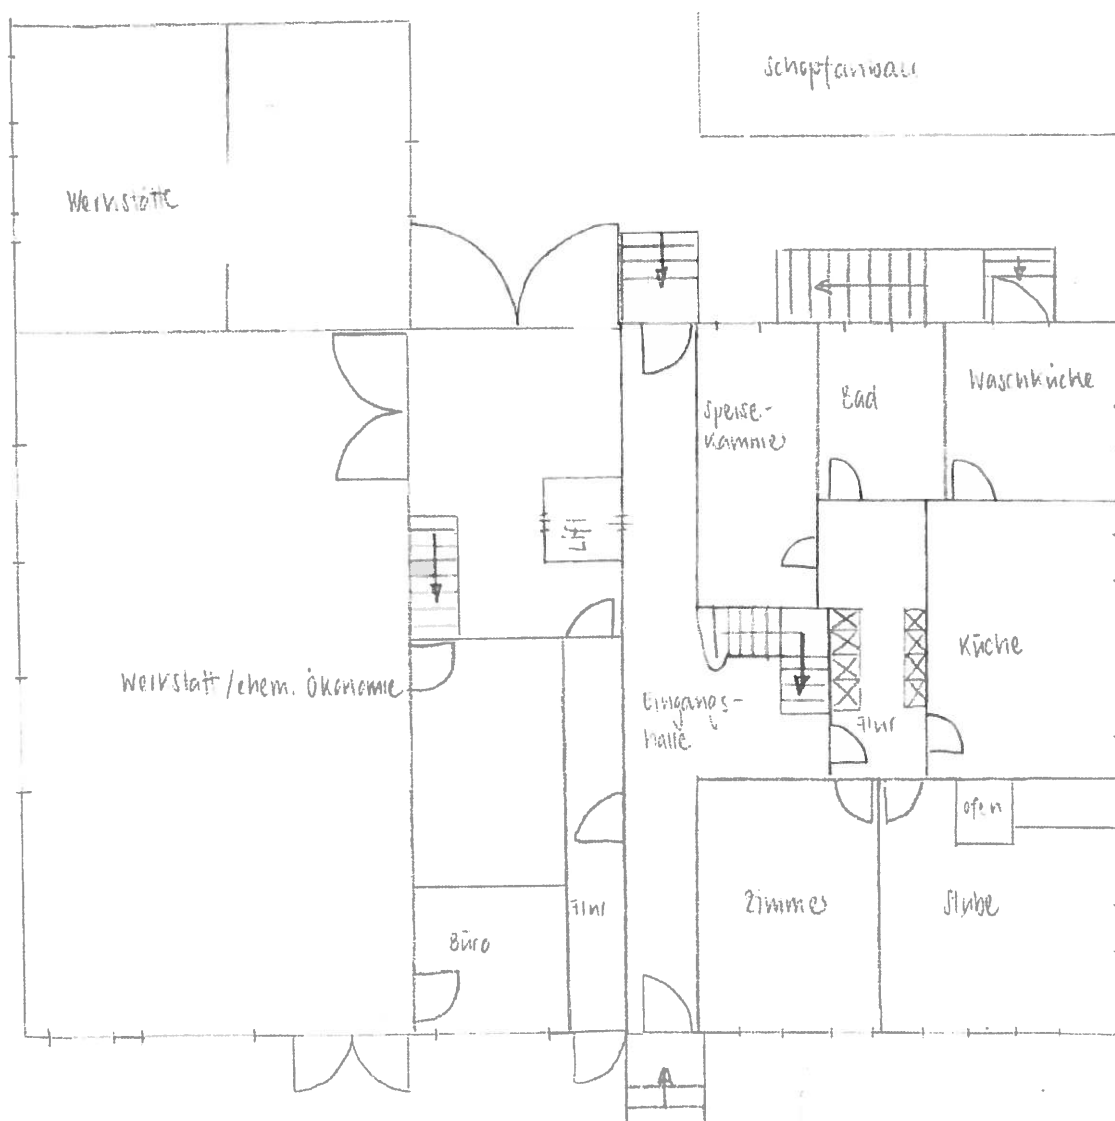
Grundriss Erdgeschoss, Skizze IBID 2015. Auf dem Plan fehlen mutmassliche Einbauten in der Werkstatt/ehemaligen Ökonomie.
